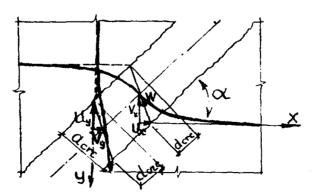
Схема перемещений арматурного стержня в трещине между берегами бетонной матрицы
